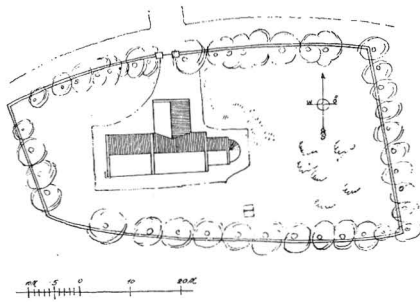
Kävlinge gamla kyrka. Situationsplan. Delin. N. Grafström och S. Anjou 1919. Lageplan. — Plan of site.
